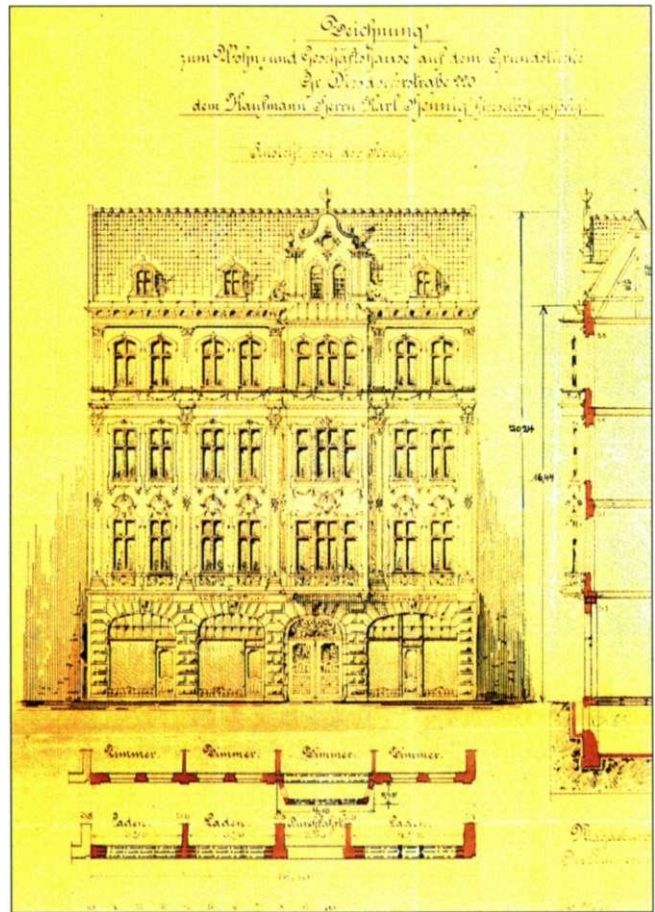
Große Diesdorfer Straße 220, Fassadenaufriß
